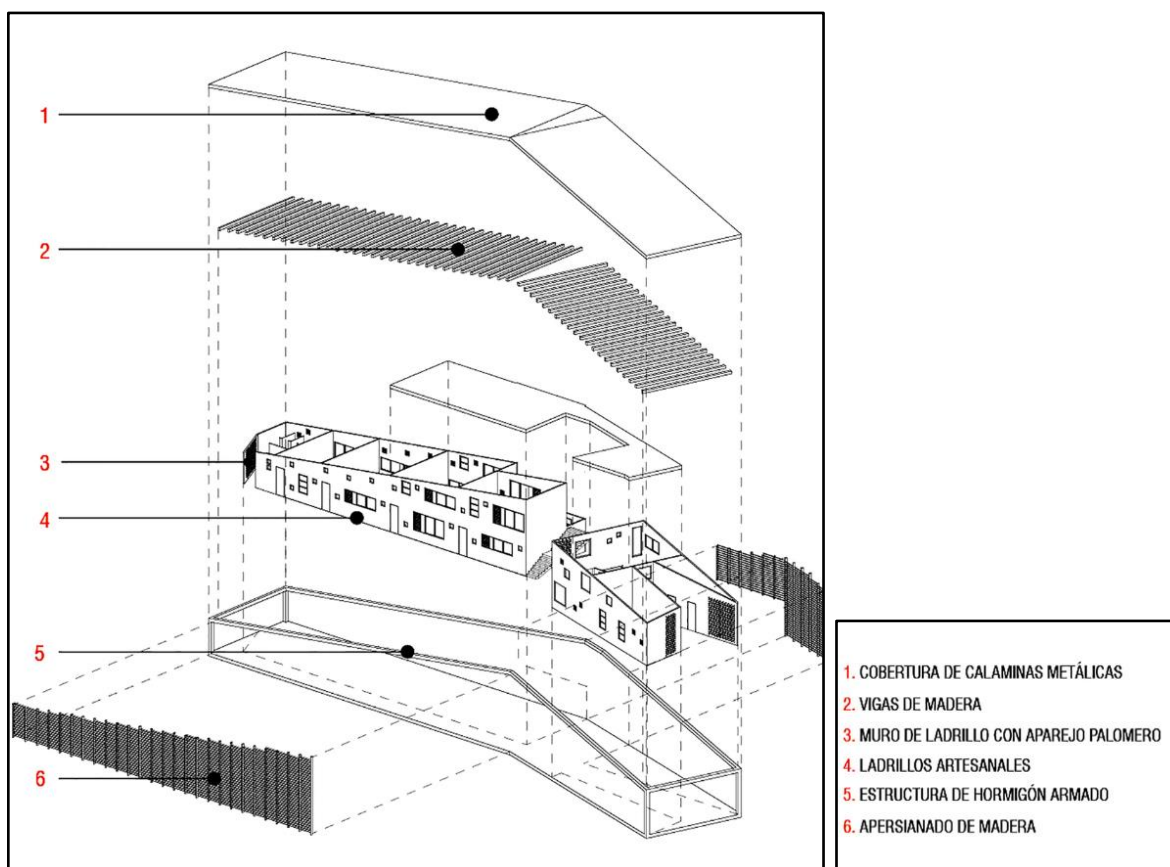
Redimensionamiento de la escuela secundaria Santa Elena.
